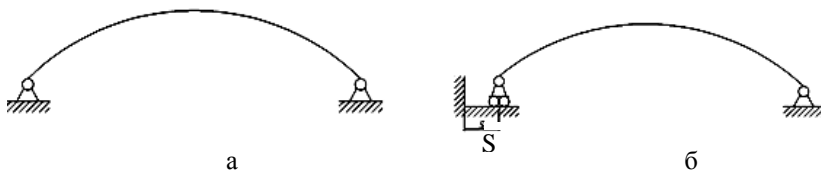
Расчетные схемы круговой двухшарнирной железобетонной арки: а – с двумя неподвижными опорами; б – с одной неподвижной и со второй подвижной опорой.
